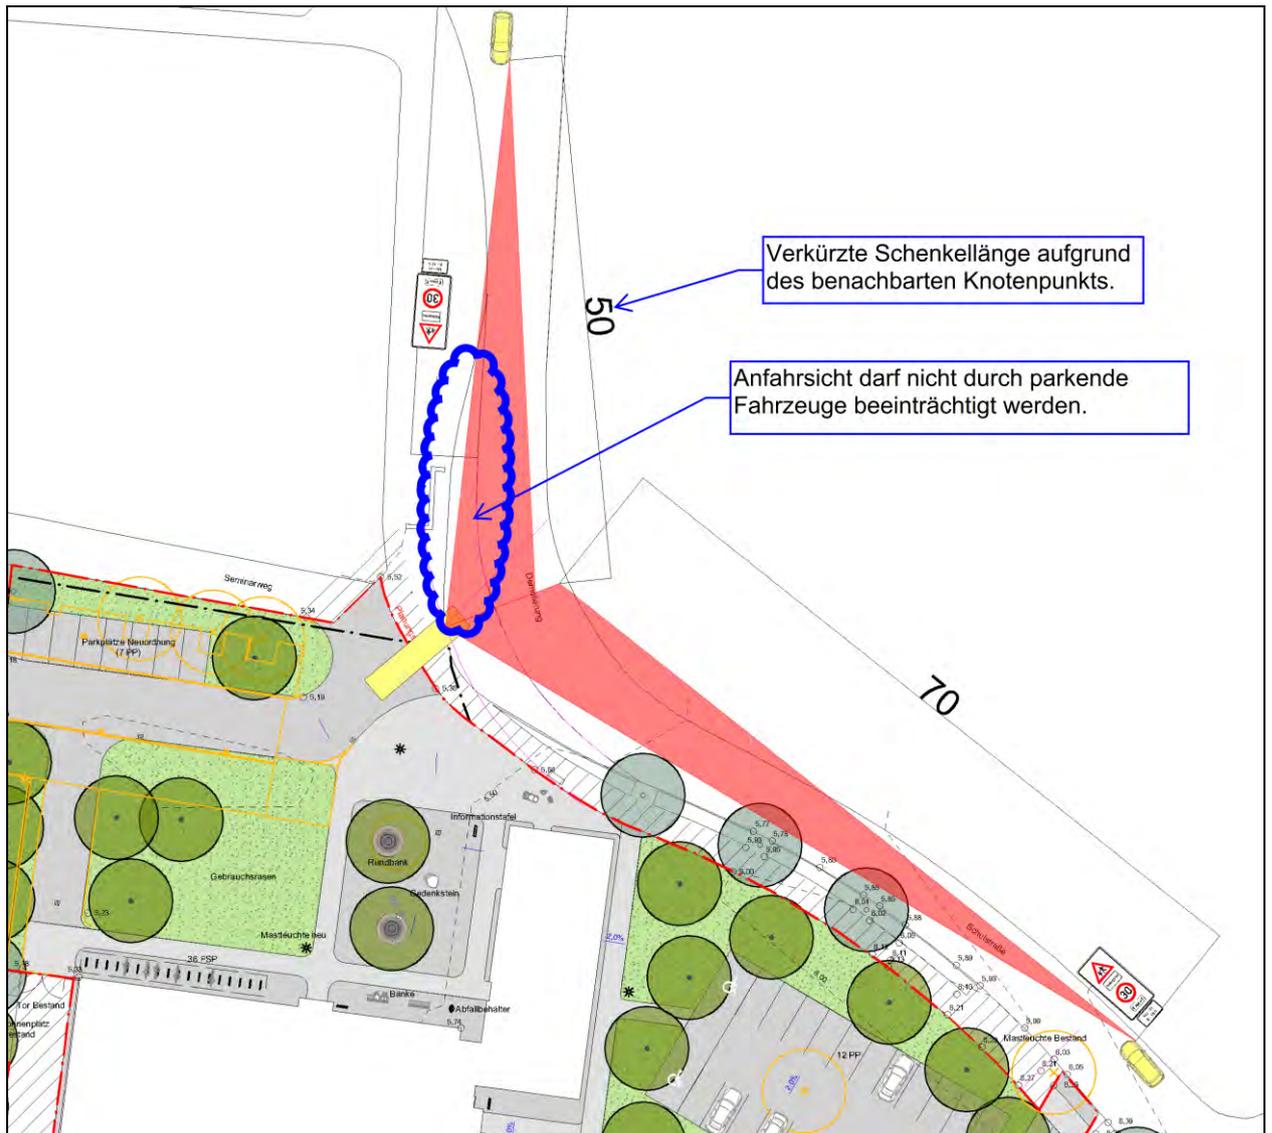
Anfahrtsicht – Parkierungsanlage West
